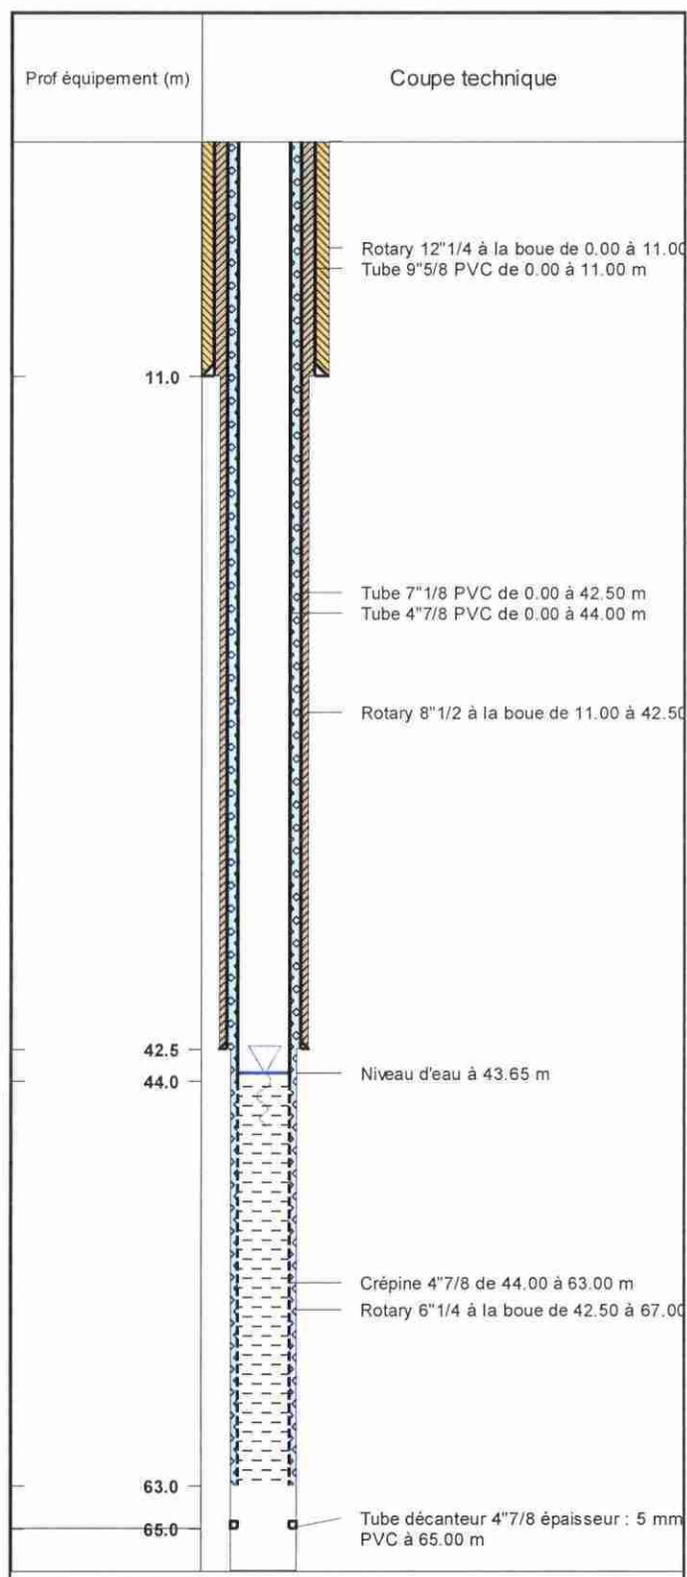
Coupe technique du forage "Jacoulet" à Saint-Morillon
